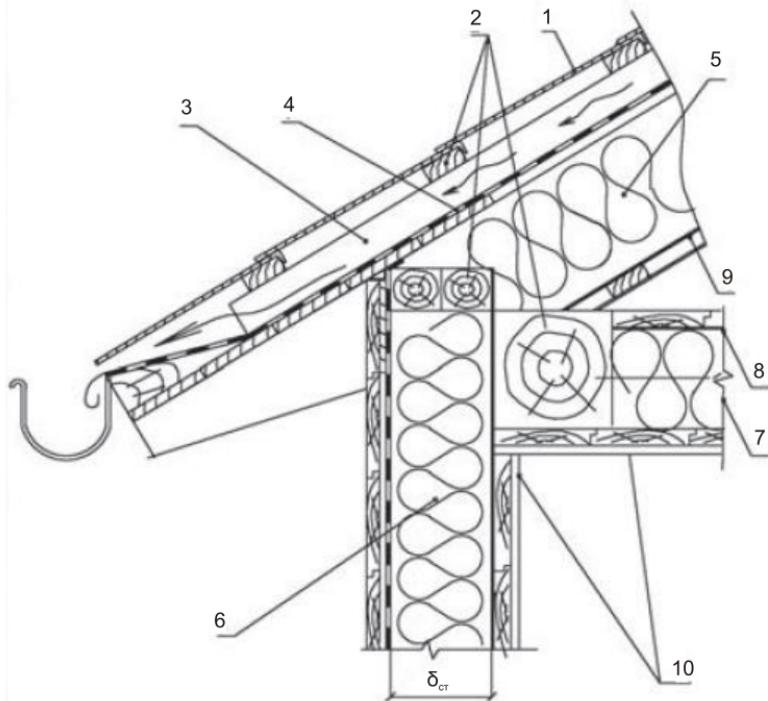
Узел сопряжения крыши и каркасной стены дома с теплоизоляционным слоем из плит ИЗОРОК: 1 — кровельное покрытие; 2 — деревянные конструкции чердака и каркасной стены; 3 — вентилируемое подстропильное пространство; 4 — супердиффузионная мембрана ISOROC FOIL HI; 5 — плиты ИЗОЛАЙТ, ИЗОВЕНТ; 6 — каркасная стена с плитами изорок; 7 — изоляция перекрытия утепленной мансарды плитами ИЗОЛАЙТ; 8 — гидроизоляция; 9 — пароизоляционная мембрана ISOROC FOIL VB; 10 — внутренняя отделка
